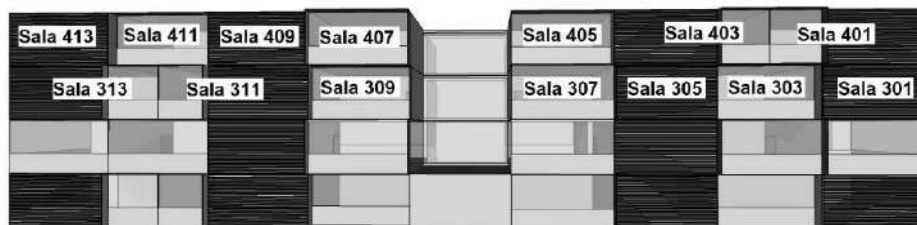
Salas 3º e 4º pavimentos fachada sudeste prédio 20. Fonte: Elaboração Própria, 2019.
